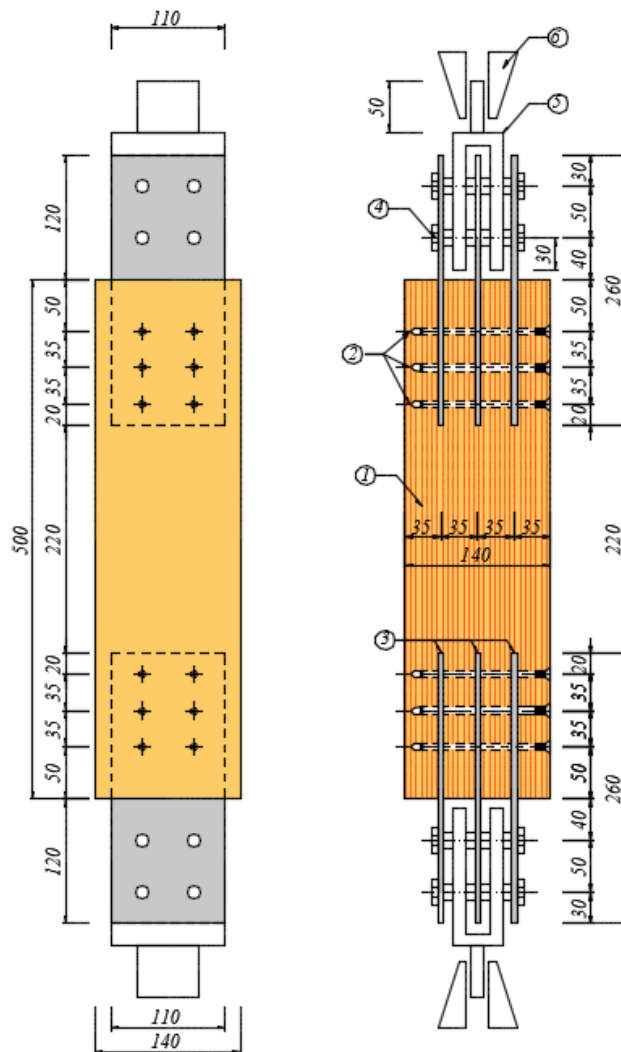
Схема испытания соединения на растяжение для схемы С-01
